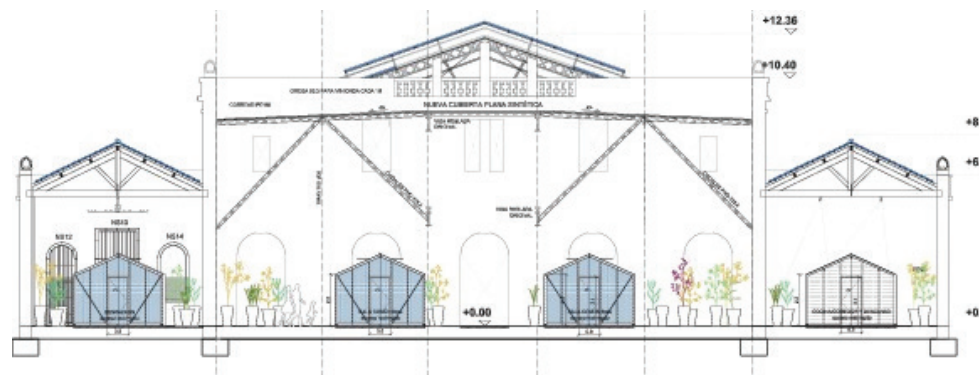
Sezione trasversale; Fonte: <http://www.manuelocana.com/>;
